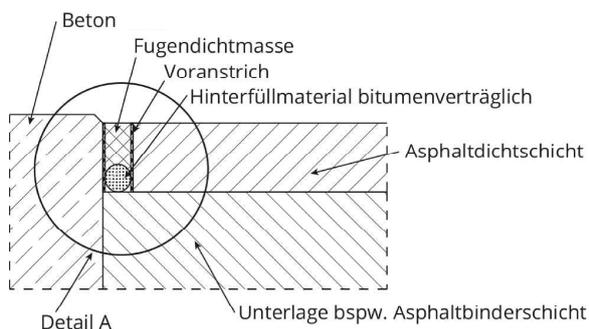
Beton/Asphalt (Kontakmaterial gemäß Anlage 6)
